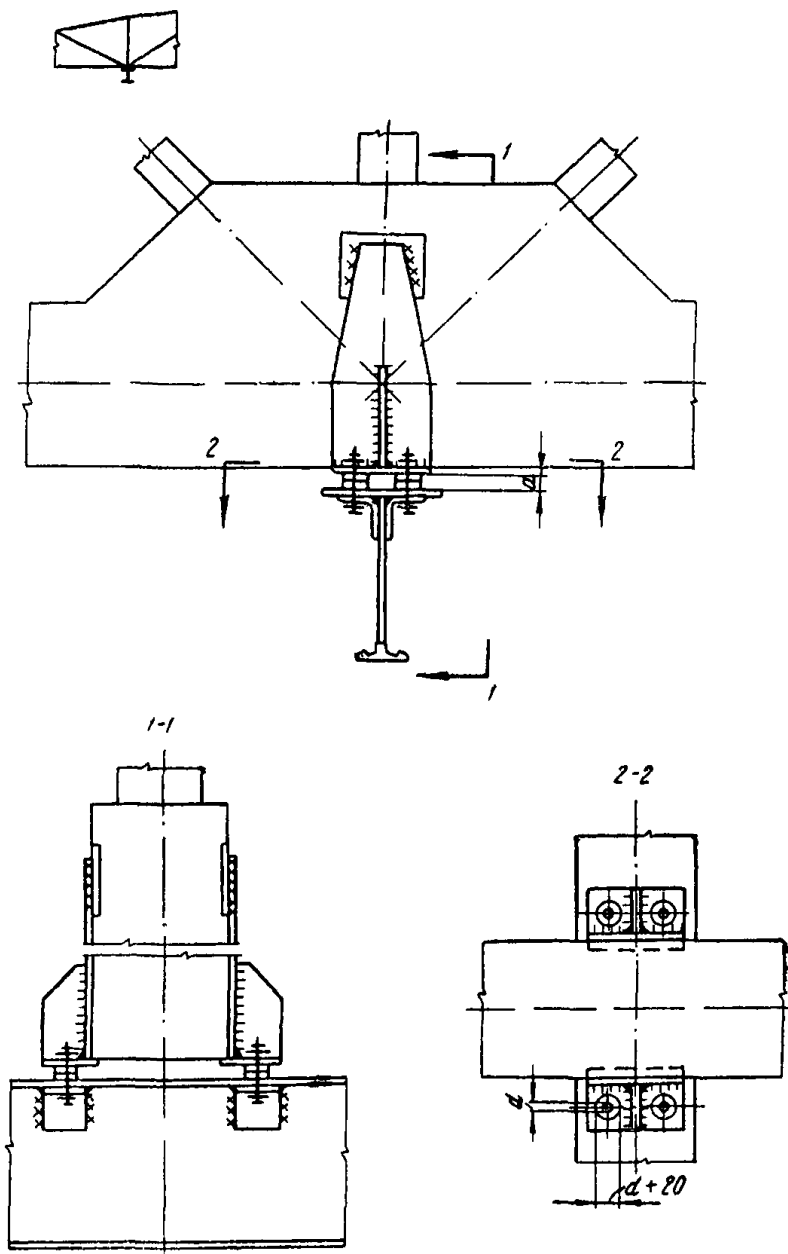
Подвеска балки в нижнем узле железобетонной фермы на закладных деталях
